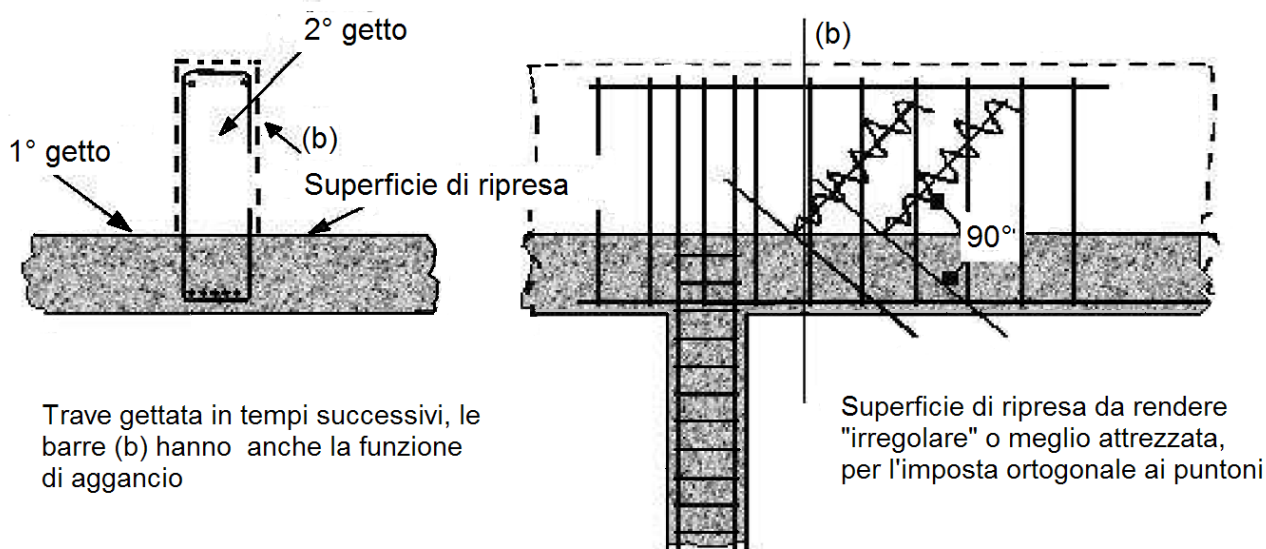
Modalità di ripresa del getto su travi di spessore elevato
